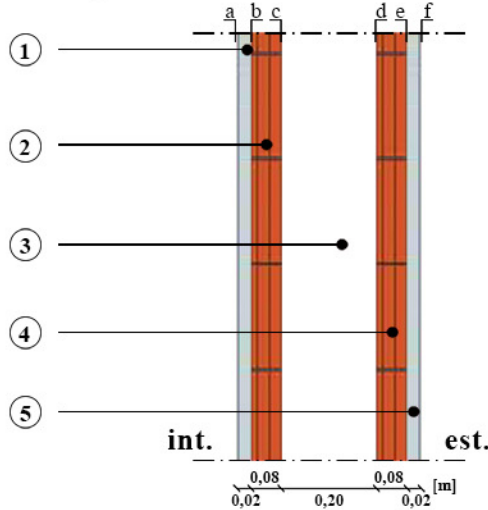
sezione del pacchetto stratigrafico dell'elemento opaco verticale di tamponamento
